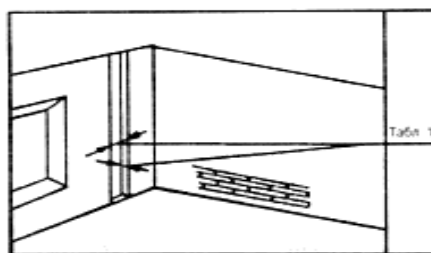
Нанесение отверстий и борозд для прокладки трубопроводов
